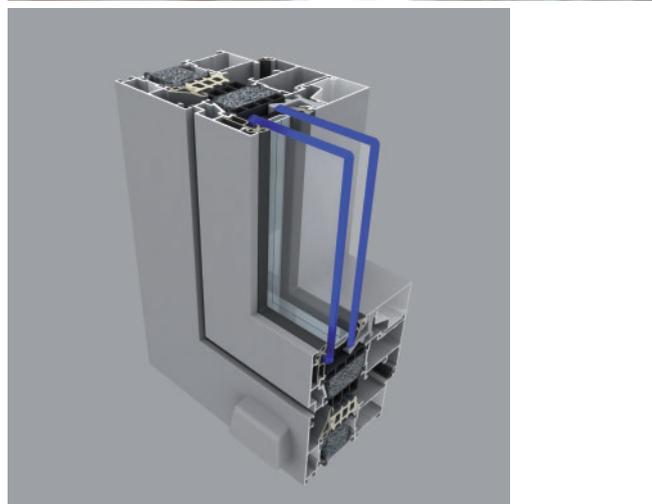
Die SCHÜCO E2 Fassade ermöglicht eine vollintegrierte Energiefassade.
